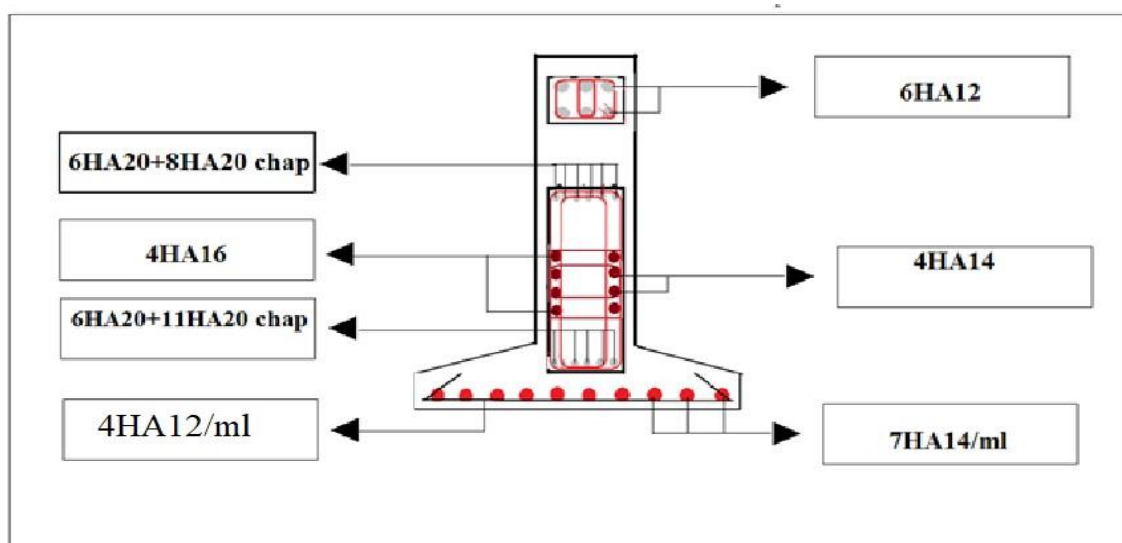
Schéma de ferraillage de la semelle filante et la poutre de rigidité
